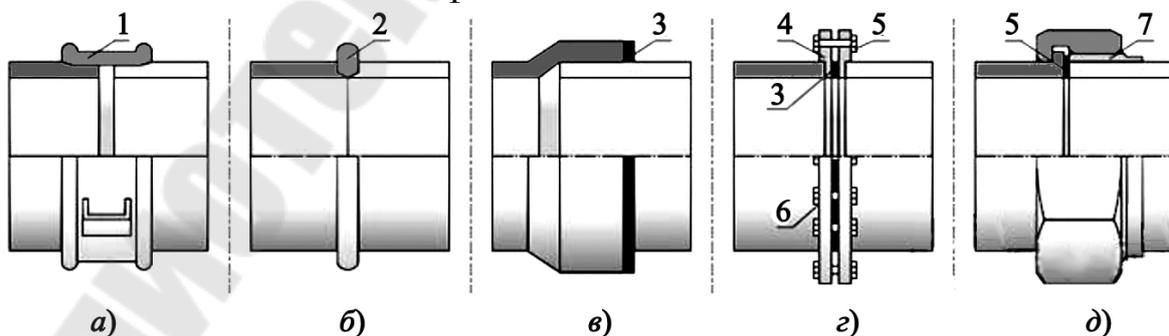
Виды соединения стальных труб: а) резьбовое, б) сварное стыковое, в) сварное внахлест, г) фланцевое, д) с накидной гайкой; 1 - муфта; 2 - сварной шов; 3 - раструб; 4 - фланец; 5 - уплотнительная прокладка; 6 - болт с гайкой; 7 - накидная гайка.
